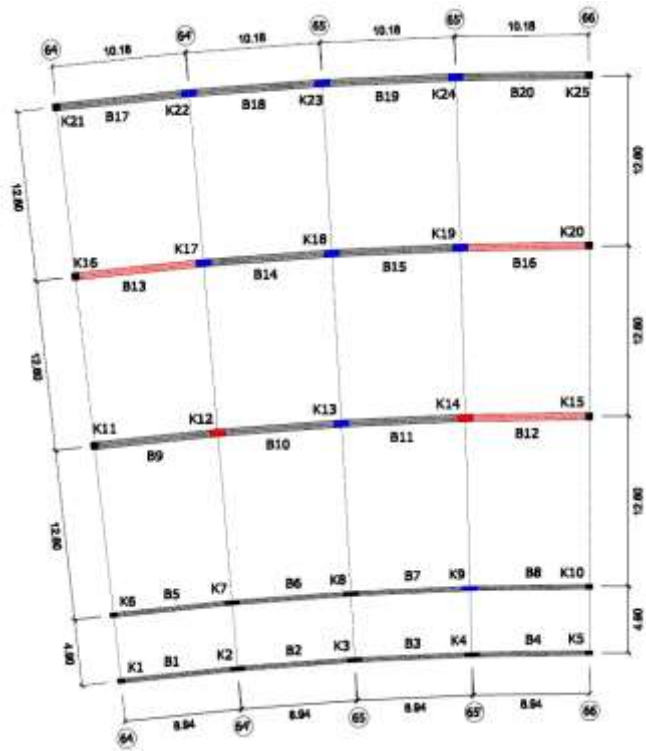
Lokasi Balok dan Kolom Terminal 1A Anjungan 2 Lantai 1 (Area : Breakdown)
